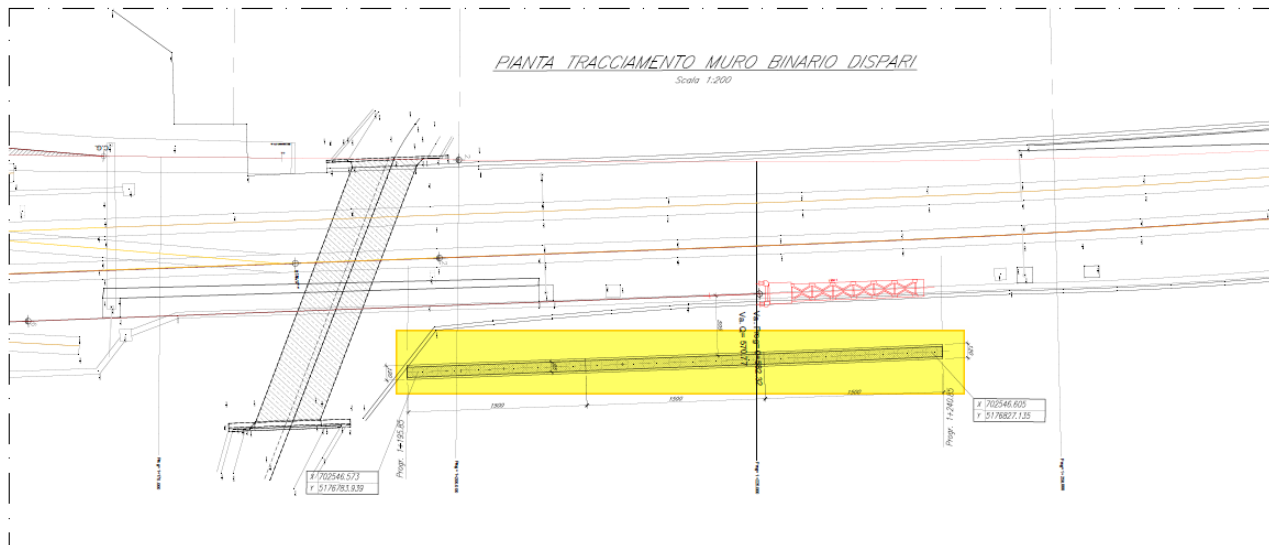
Individuazione Muro in c.a. su fondazioni profonde binario dispari – Planimetria
